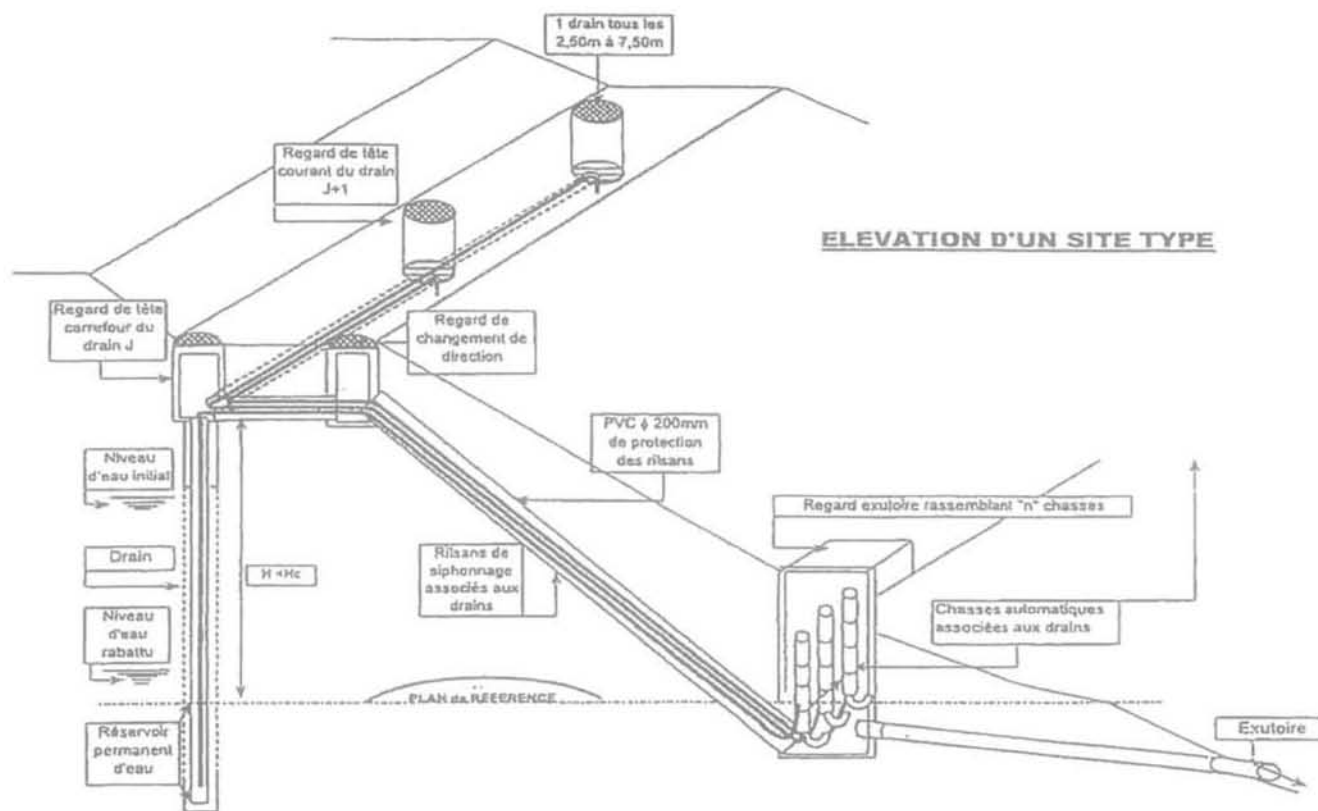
Coupe en travers type sur un réseau de drain siphon.
